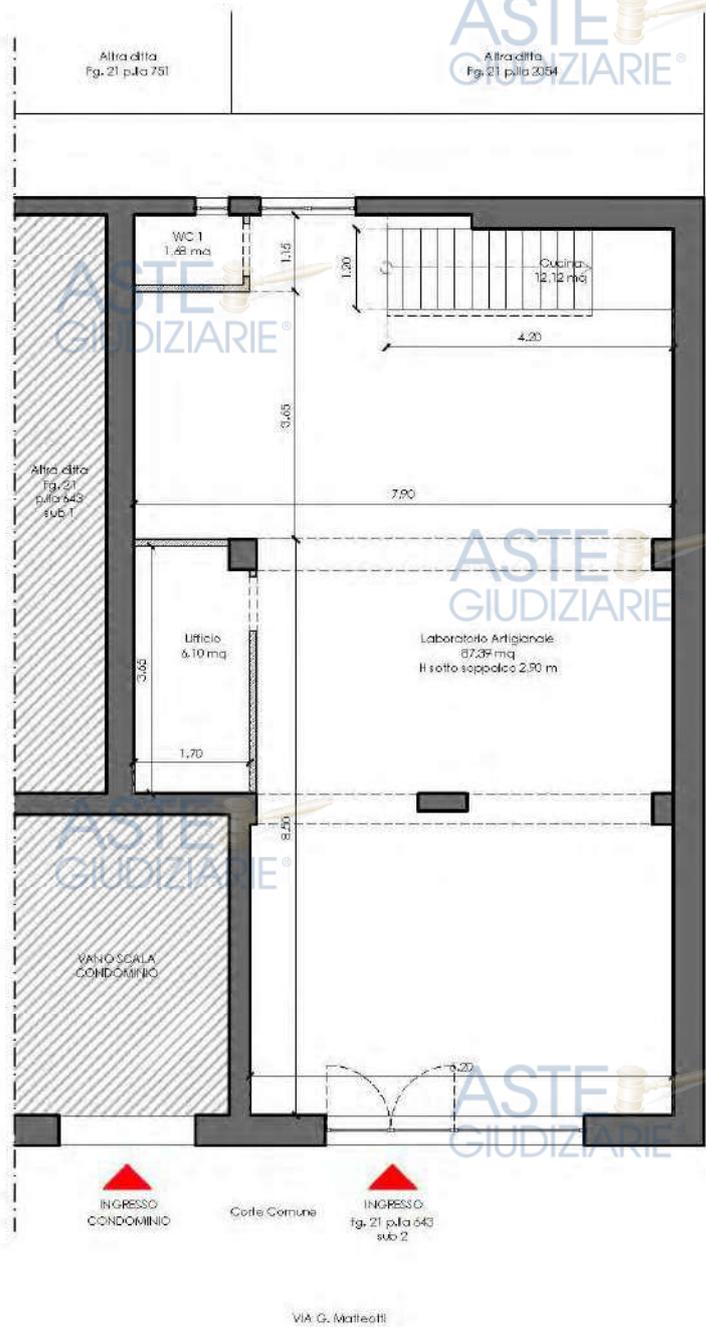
Rilievo laboratorio per Arti e mestieri Lotto Unico Stato di fatto _ pianta piano terra (Allegato 6D)
